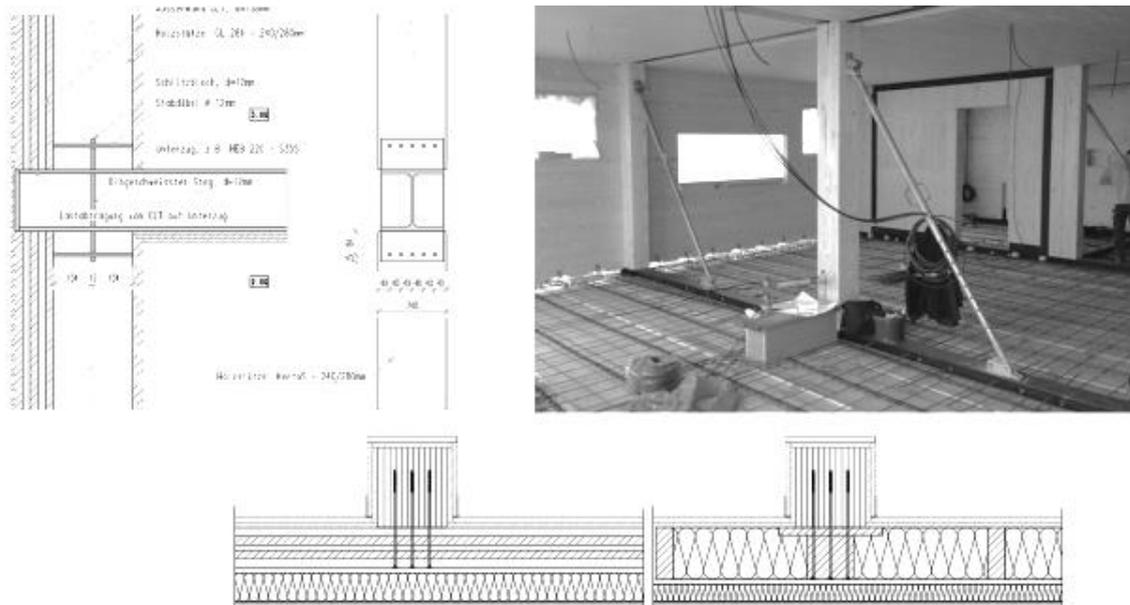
Konstruktionsprinzip beim C13 mit der tragenden Skelettkonstruktion und den nichttragenden Aussenwänden. Rechts eine Bild im Montagezustand.
